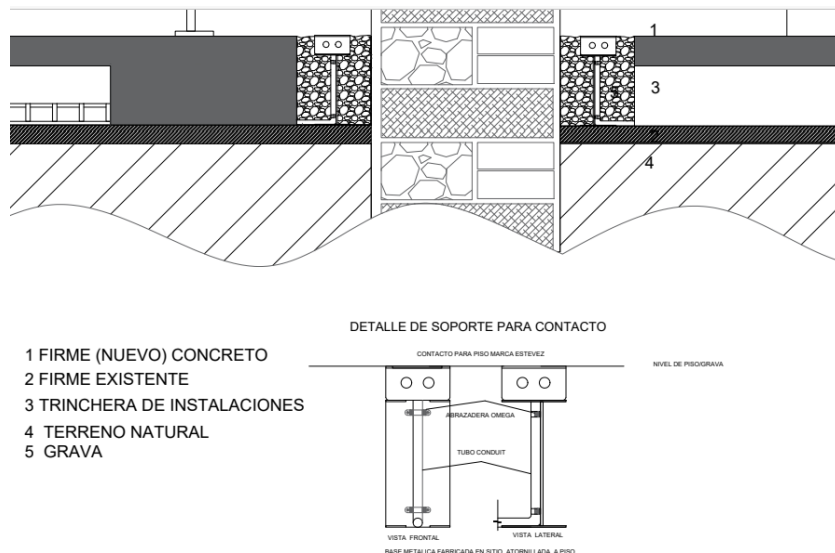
detalle de paso de instalaciones eléctricas por muro. Elaboración propia
